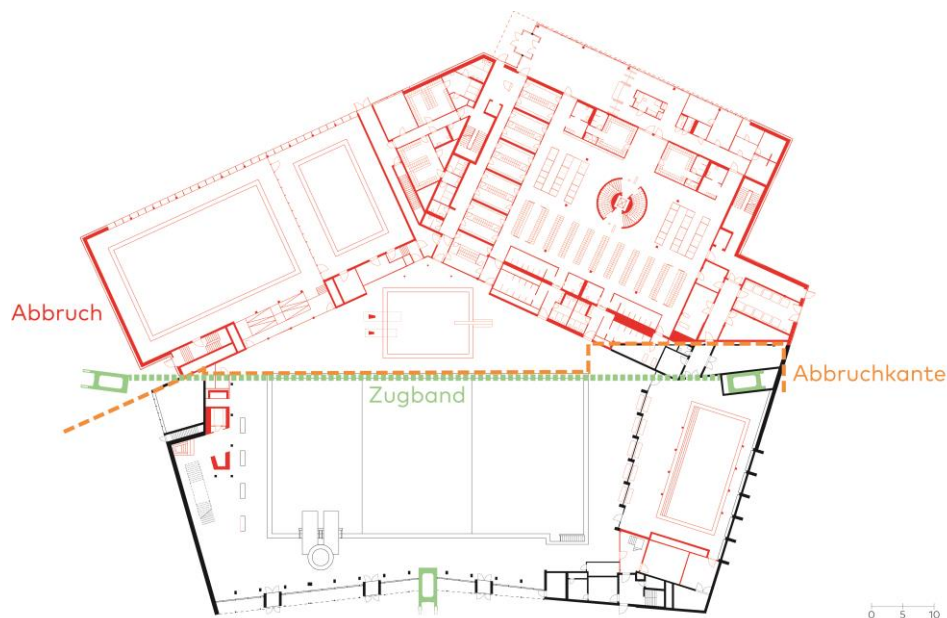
Grundriss der Alsterschwimmhalle mit Abbruchkante und der Lage des Zugbandes
